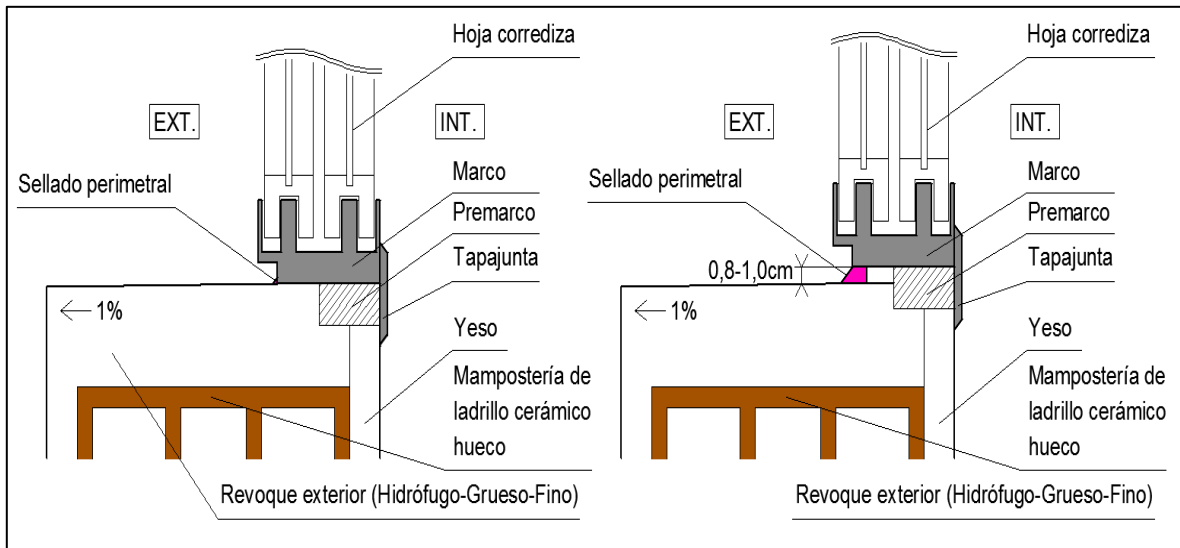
Detalle de sellado perimetral exterior en aberturas de aluminio.
